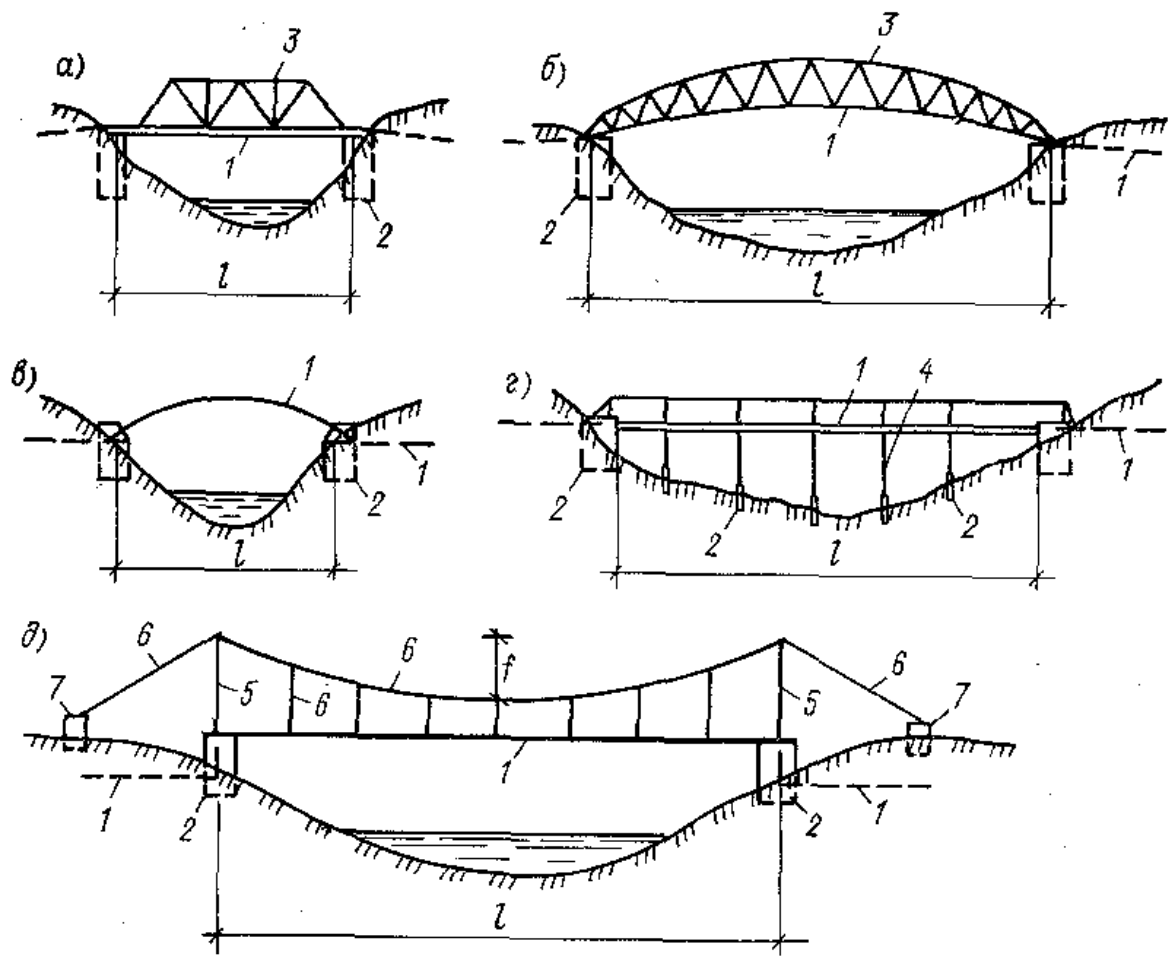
Схеми повітряних переходів газопроводів:
